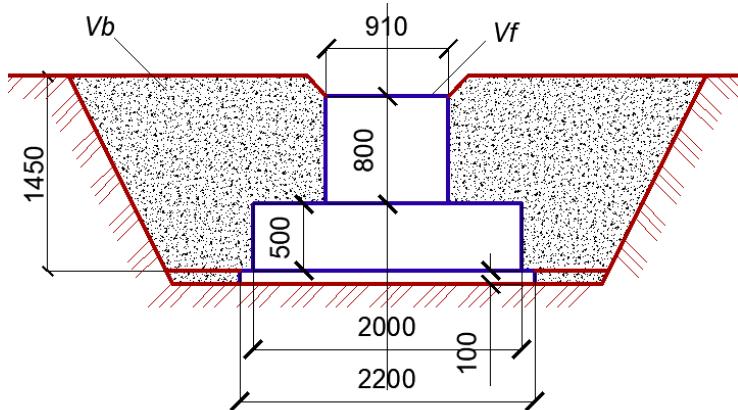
Схема зворотної засипки ґрунту в пазухи фундаменту
